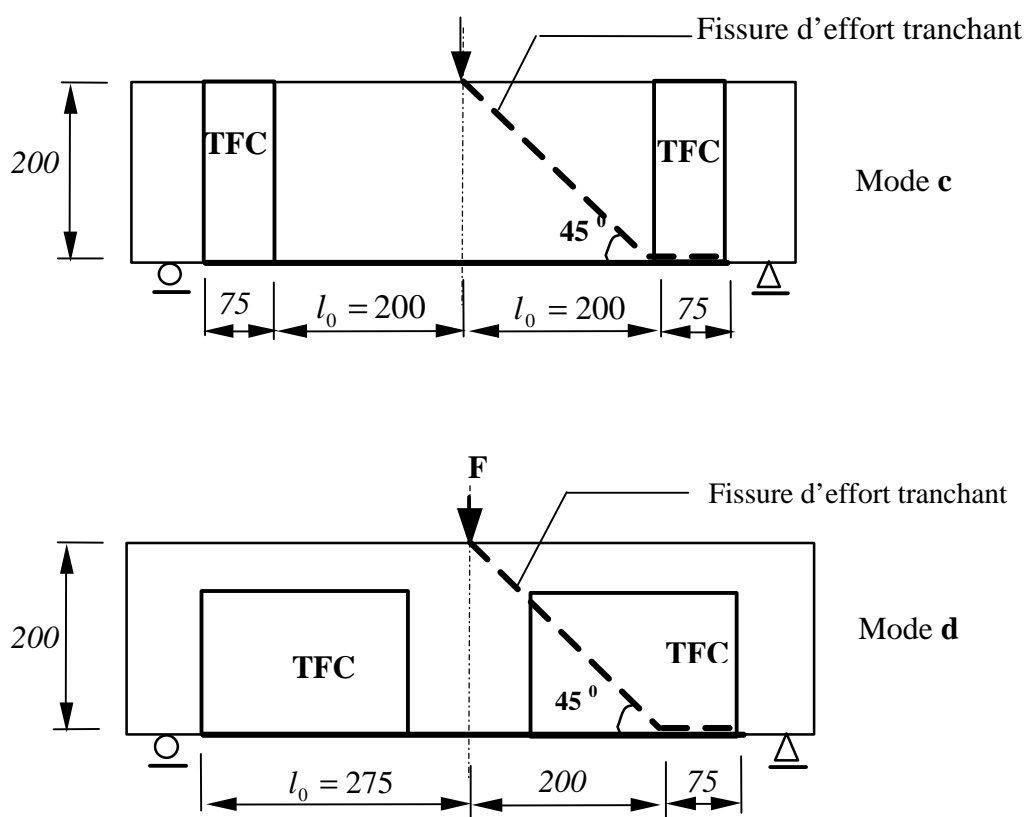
Schémas de la fissuration d'effort tranchant des poutres renforcées en mode c ou d (unité: mm)
